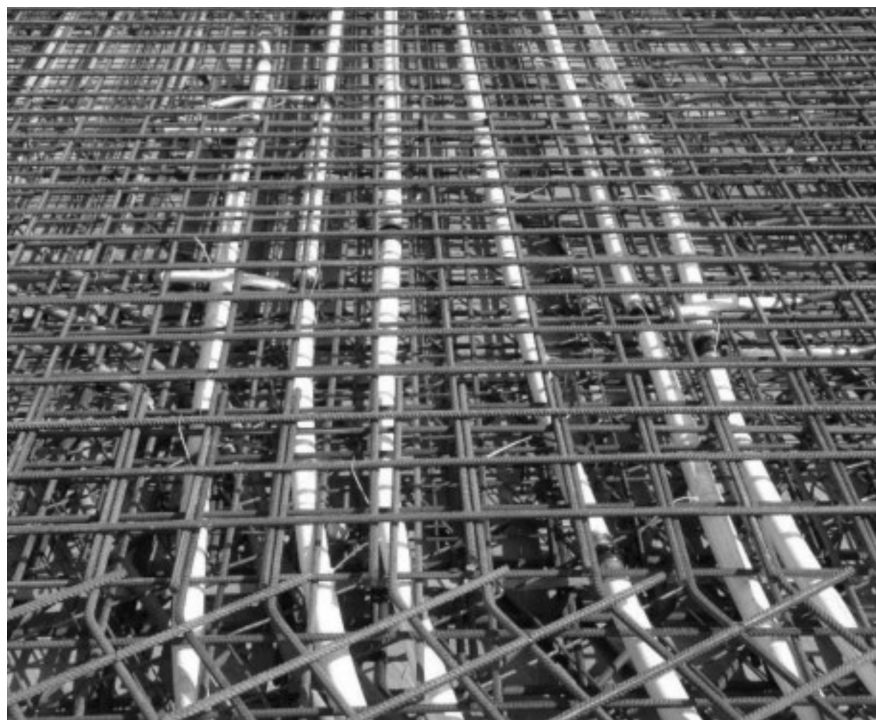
Hauptverteilungsleitungen einer deckenintegrierten Flächenheizung in einer Stahlbetonflachdecke vor Betonage.
